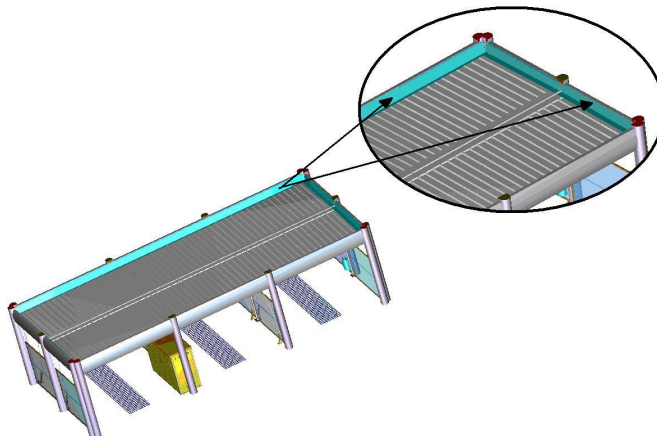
Faldali con tetto piano e "ALU LOOK CLASSIC"
